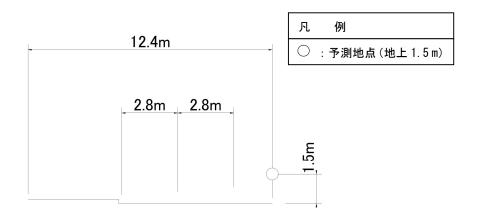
(3)予測断面図(C.村道 16 号線沿道(宮田村 6747-5 地先))
